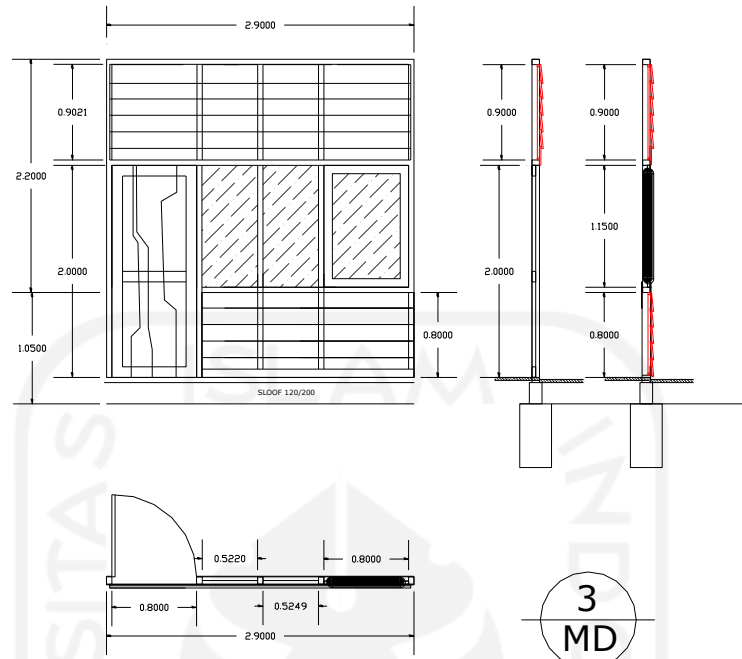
Denah Rencana Dinding Huntara Tipe 36
